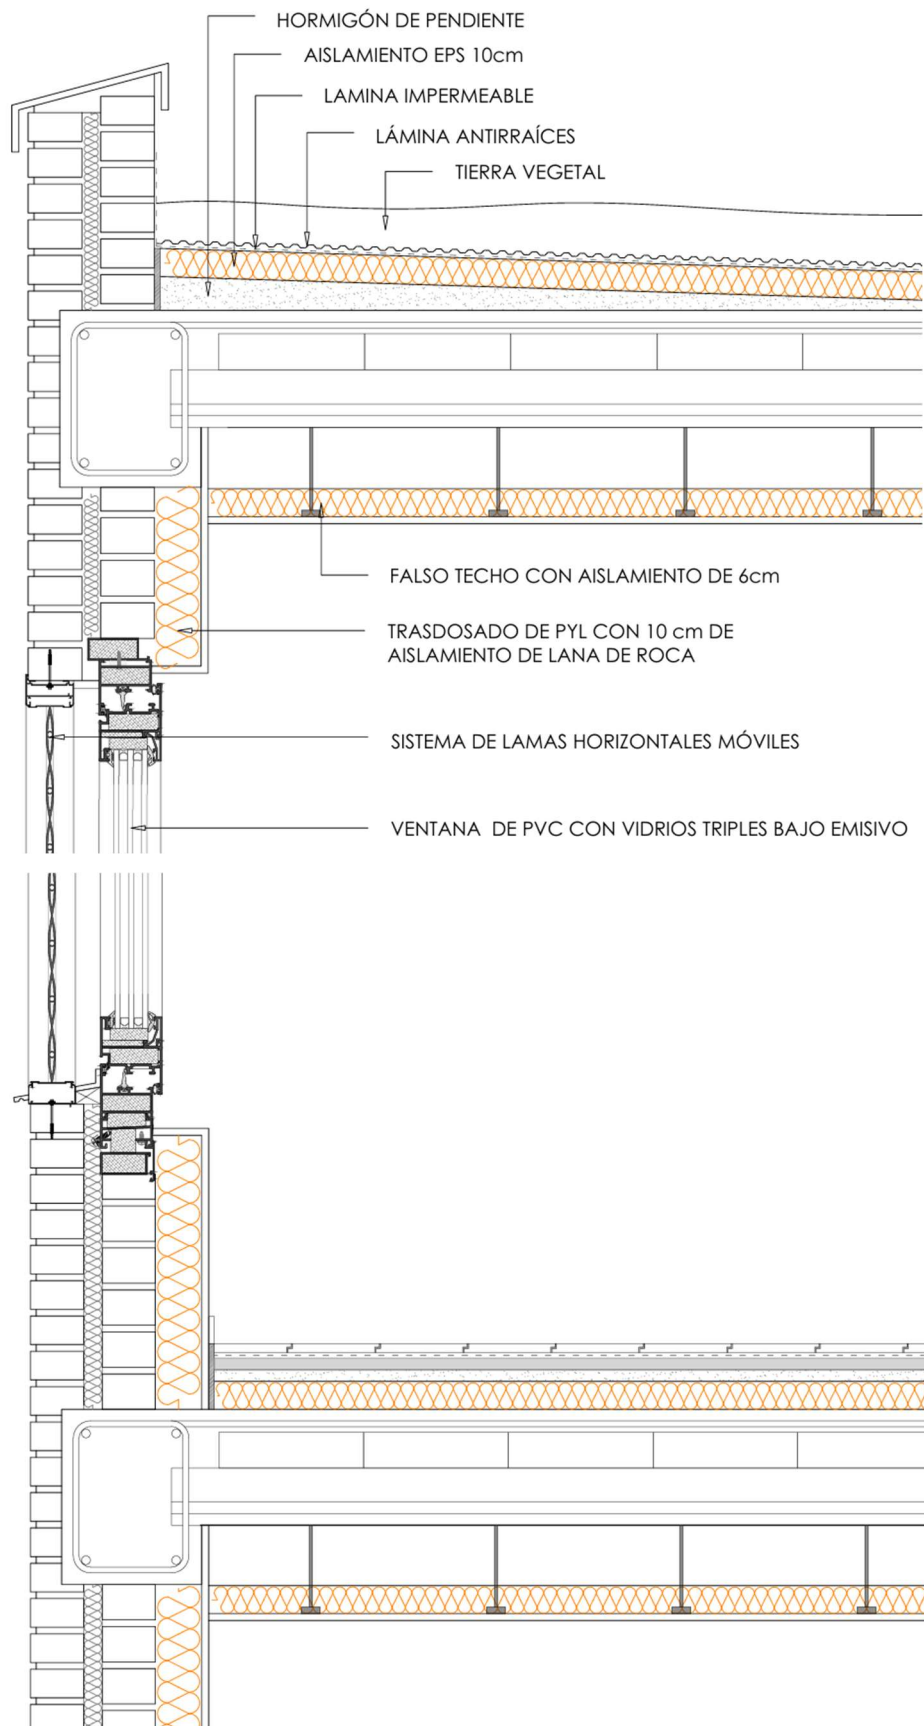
DETALLE PROPUESTA ENCUESTRO FACHADA CON CUBIERTA CEIP INFANTAS ELENA Y CRISTINA
